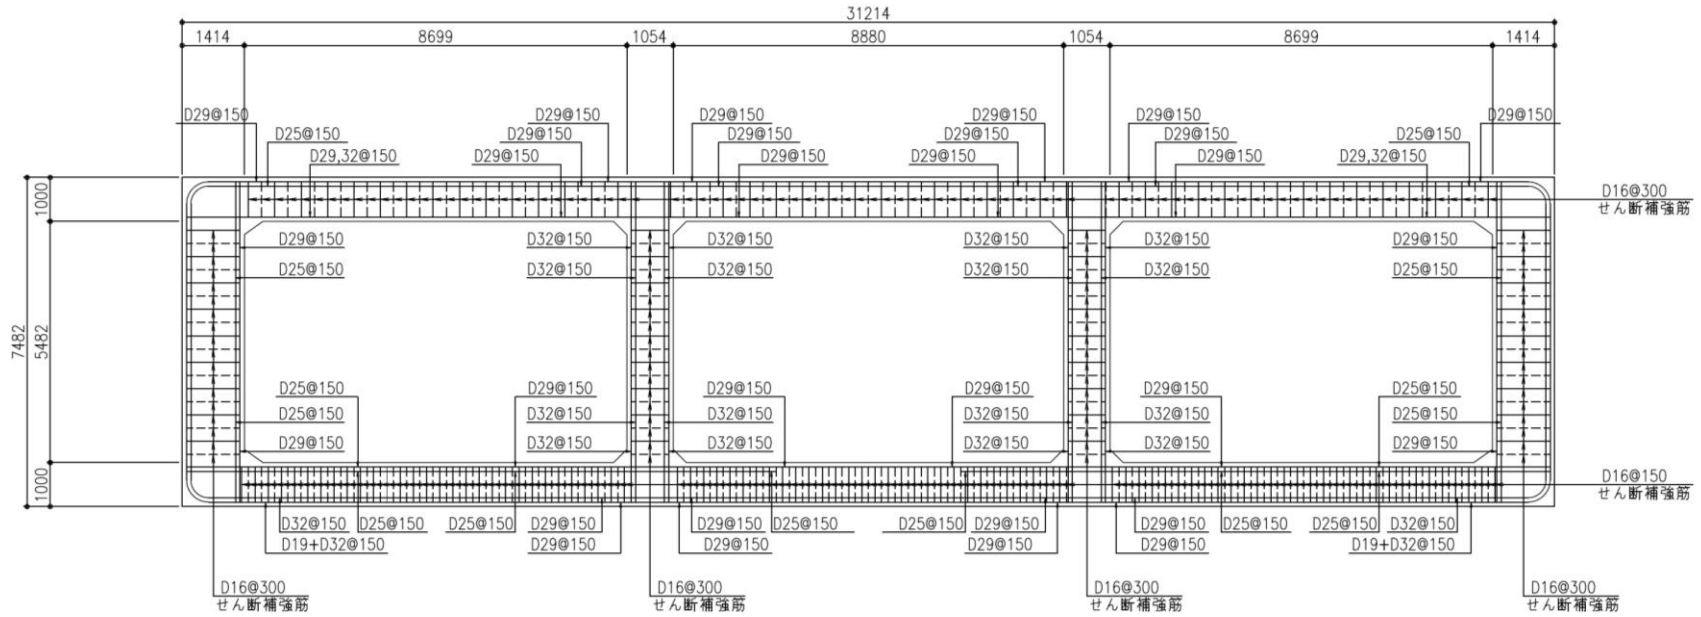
(2) 取水路の断面図 (一般部 B-B 断面)
